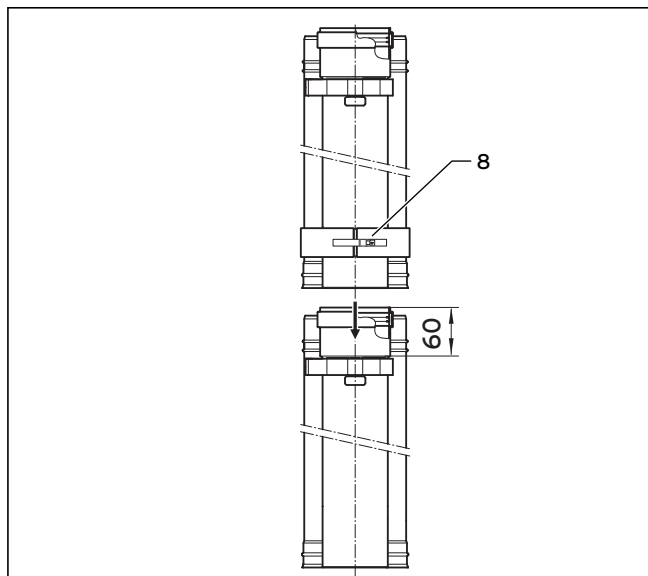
Montaż przyłącza przewodu na ścianie zewnętrznej
